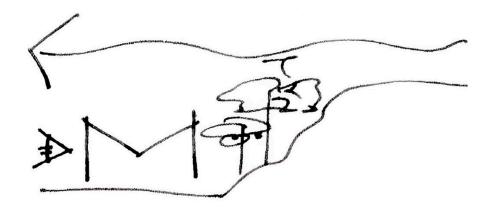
Cubierta mariposa | Primer acercamiento al contexto del terreno
